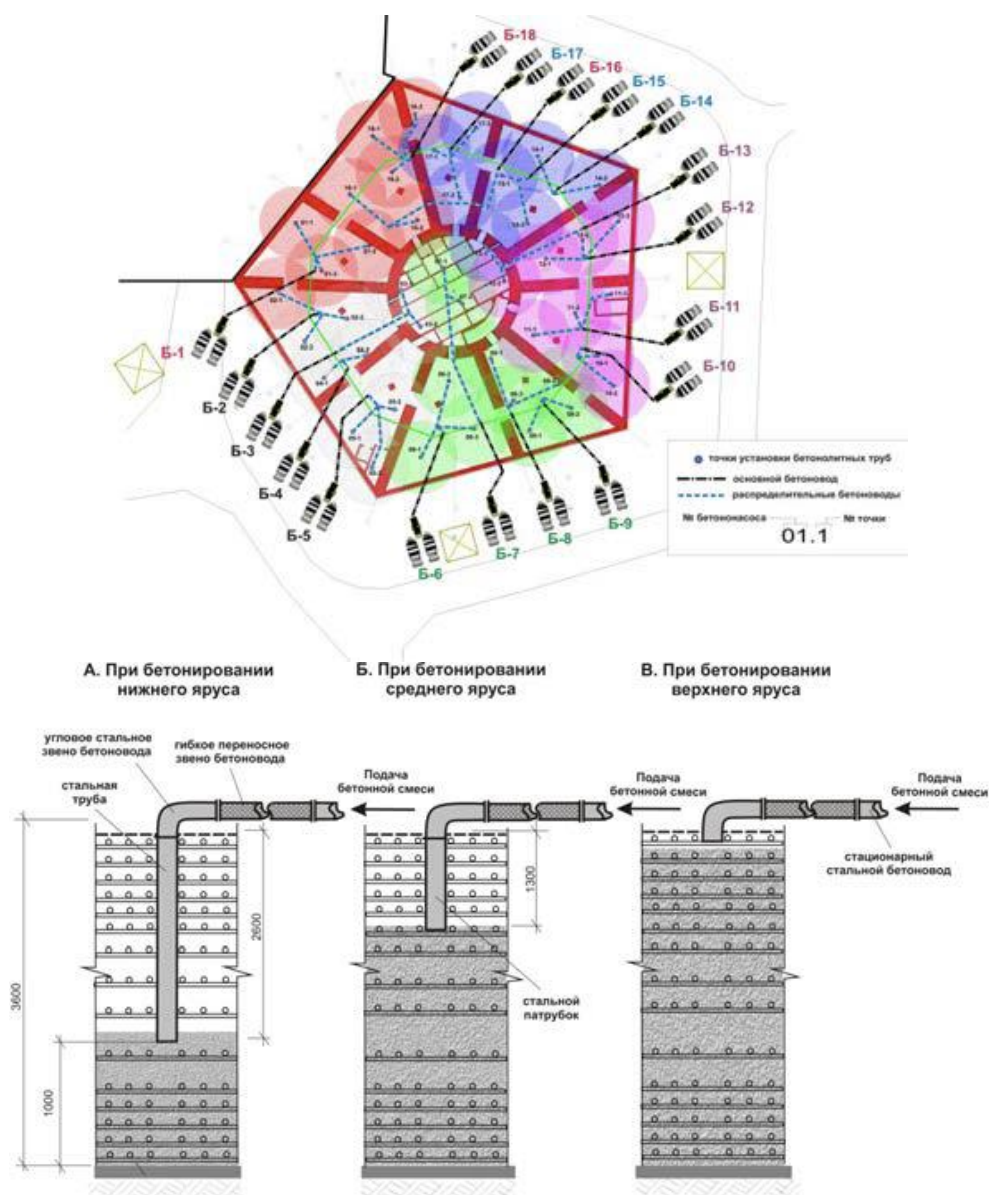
Схема укладки бетонной смеси и направление фронта бетонирования
